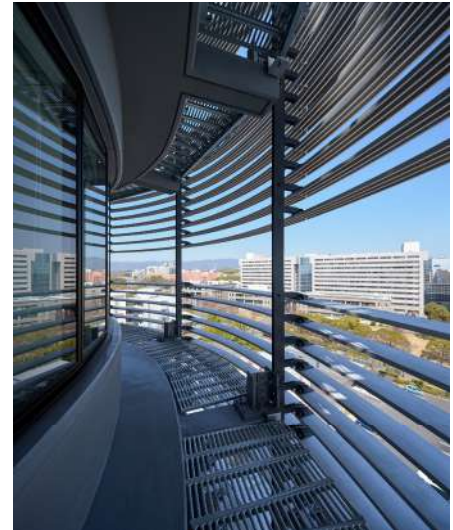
アルミルーバーの施工完了状況 (設備バルコニー)
